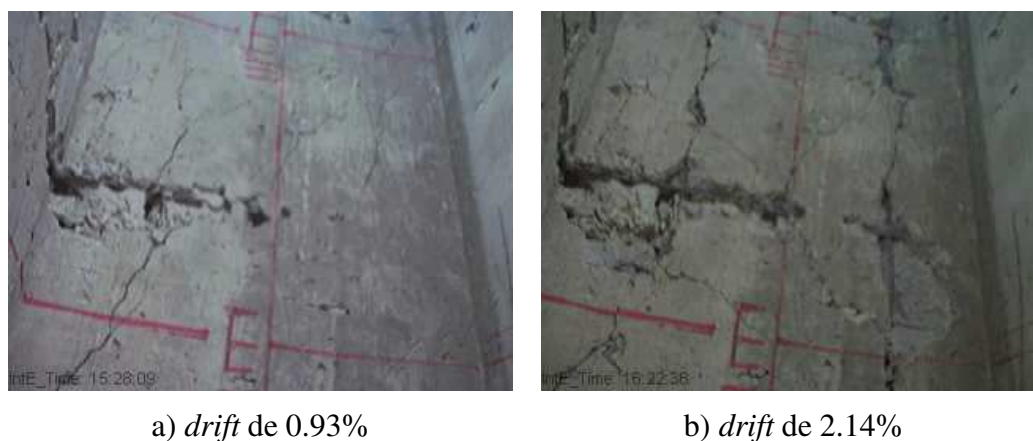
Danos na face interior Este do pilar PO2-N5
